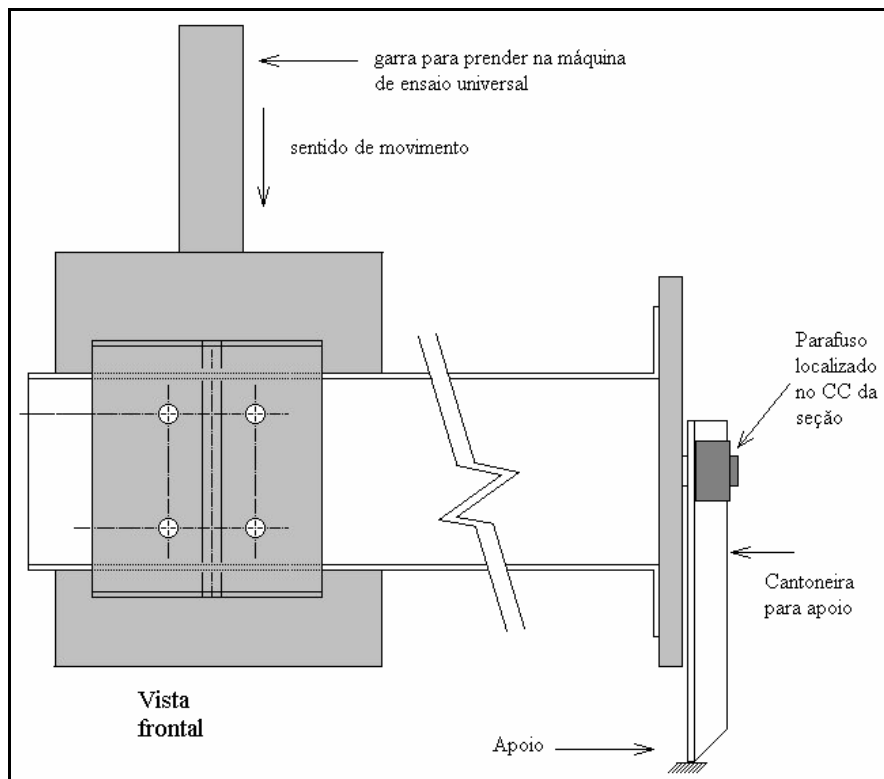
Esquema utilizado no ensaio da viga com 0,4m
